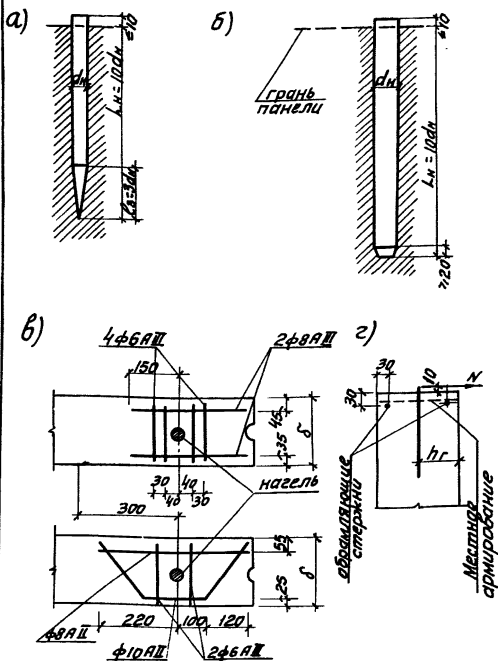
Конфигурация, основные размеры и рекомендуемые типы местного армирования;
